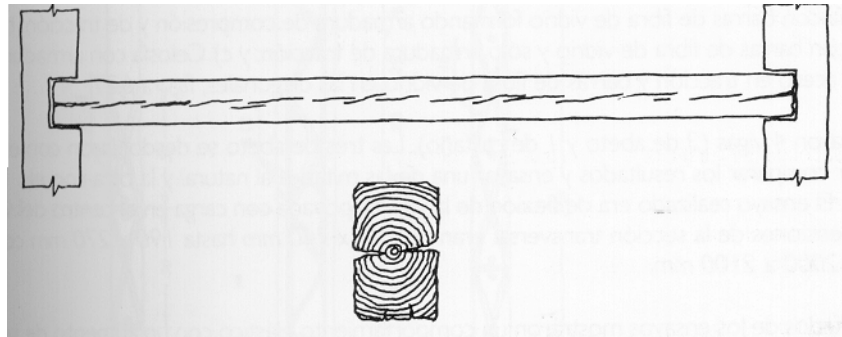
Peça de madeira fissurada (Arriaga, 2002)
